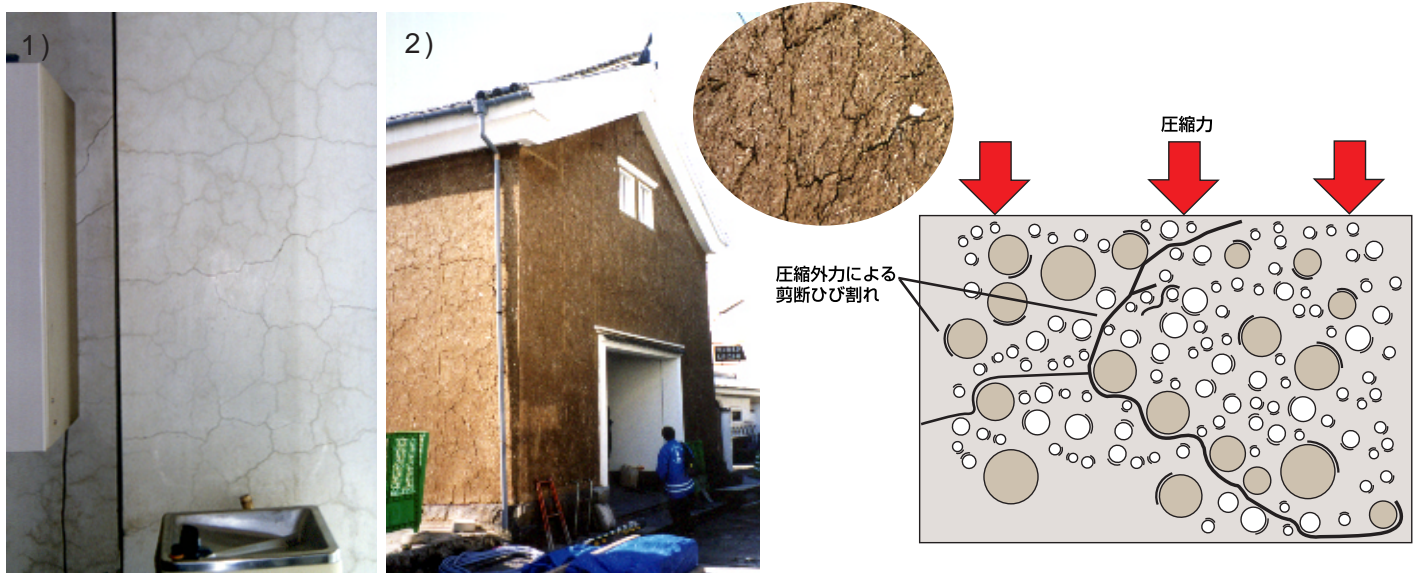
：1)モルタルのひび割れ 2)土壁のひび割れ
